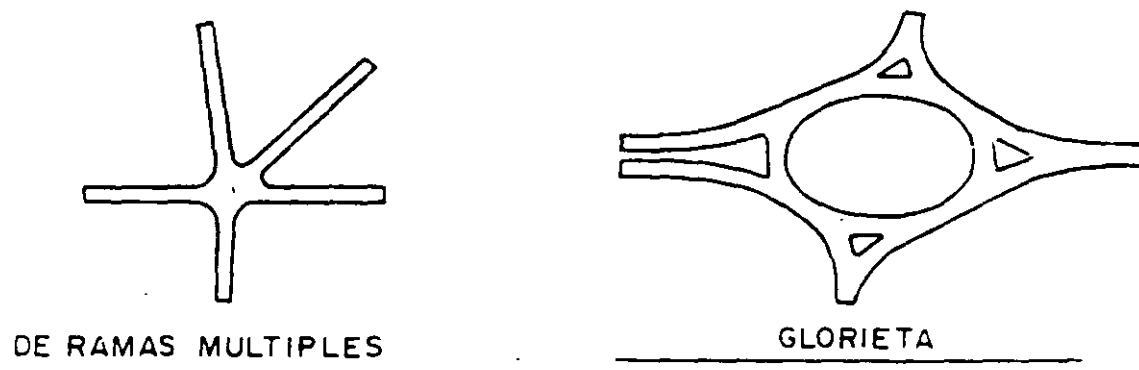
TIPOS GENERALES DE ENTRONQUES A NIVEL
